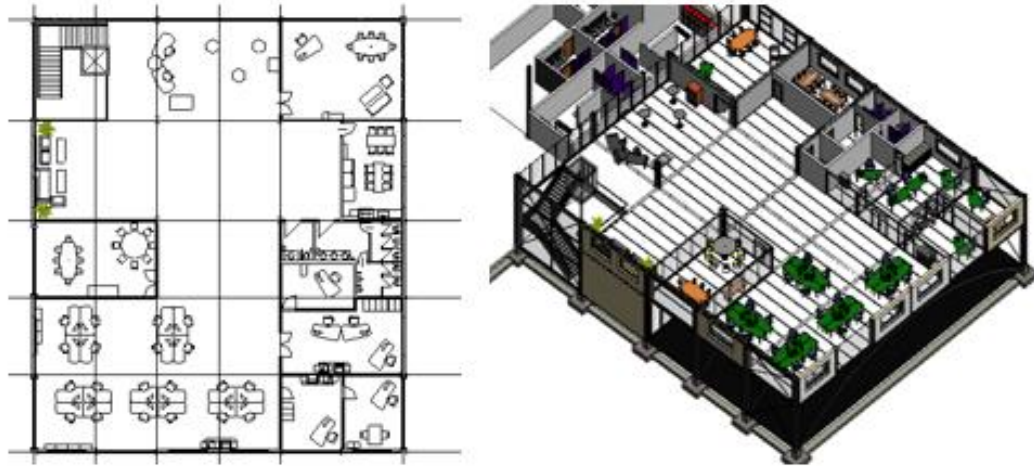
Resultado final para la propuesta de la primera planta de oficinas.
